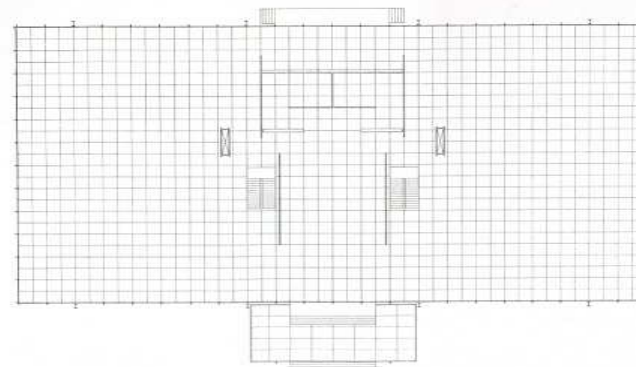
Crown Hall (planta do pavimento térreo), 1952
